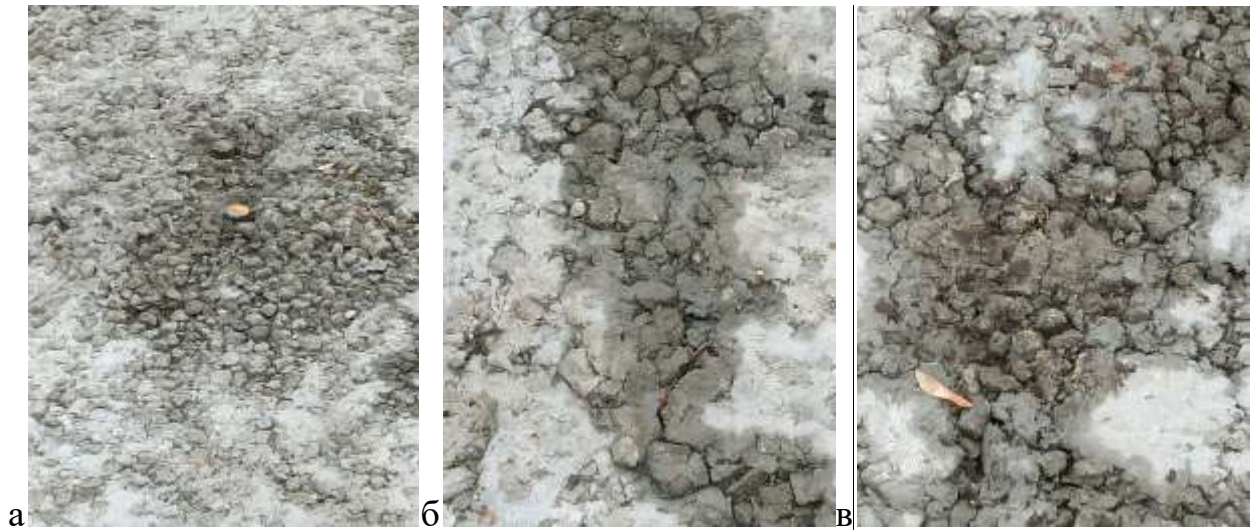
Поверхня збірних залізобетонних плит прогонової будови
